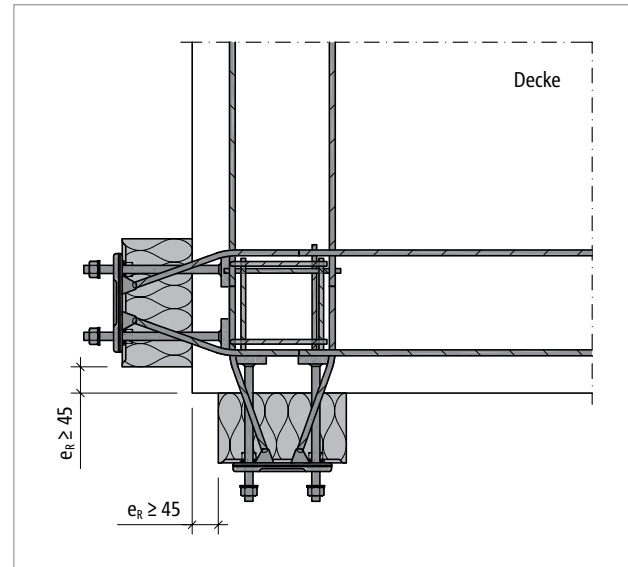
Schöck Isokorb® XT Typ SQP: Randabstände an der Außenecke bei zwei senkrecht zueinander angeordneten Isokorb®
